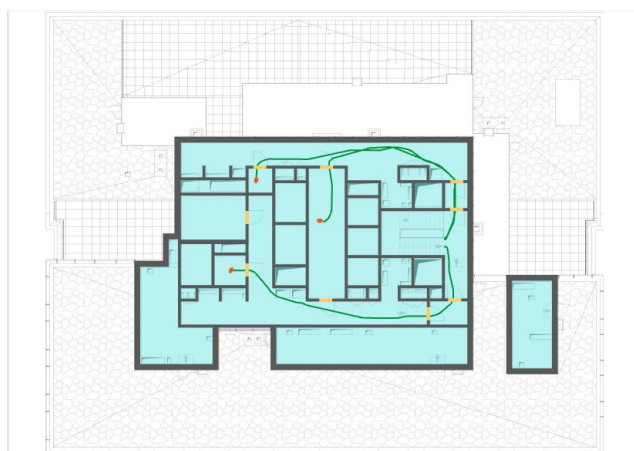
План техэтажа на отм. +116.250 и нанесенная на него расчетная (принципиальная) схема эвакуации
